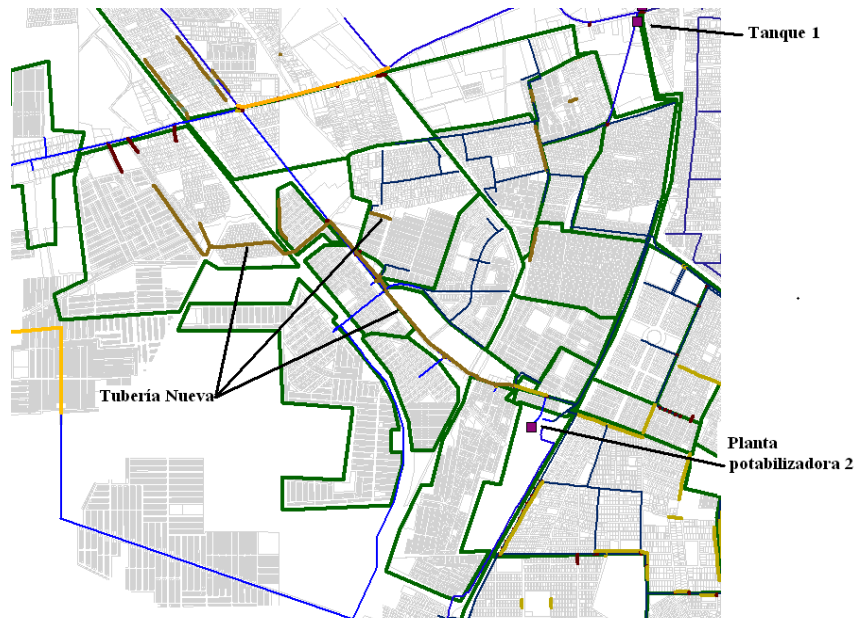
Tubería nueva para los sectores localizados al Norte y Poniente de la Planta Potabilizadora 2
